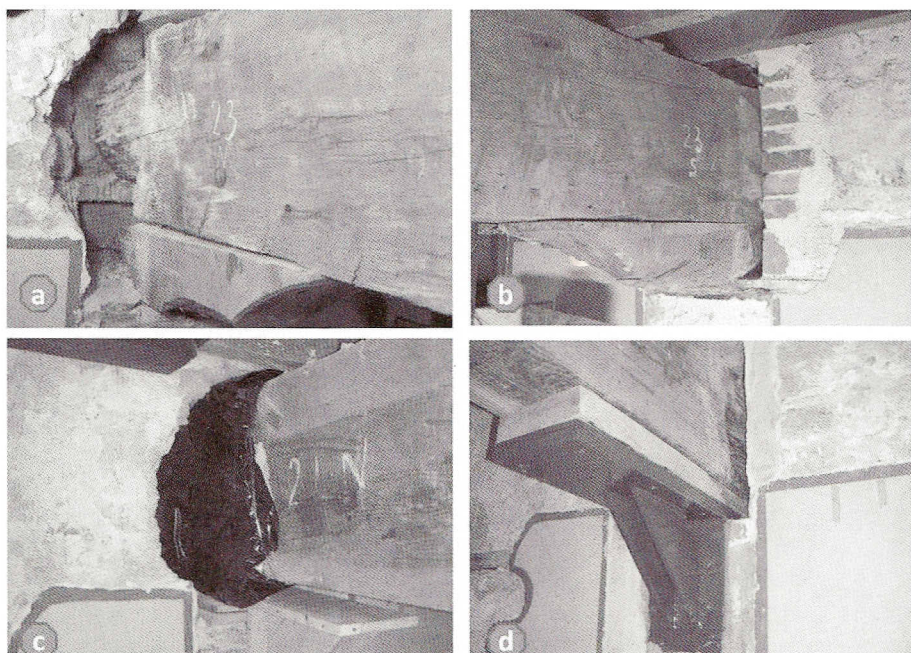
Saggi di restauro: liberazione della testata della trave dal muro (a); costruzione della nicchia di alloggiamento della testata di sezione maggiore rispetto alla sezione della trave, con pareti in mattoni pressati per favorirne la ventilazione (b); sanificazione della testata (c); sostituzione della mensola compromessa con lastra metallica (d) che verrà coperta dalla sagoma della mensola dipinta.
